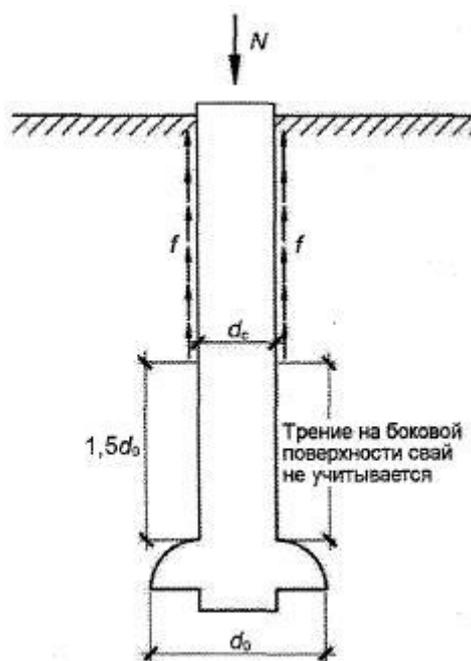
Схема к расчету сопротивления на боковой поверхности ствола сваи с уширением в песчаном грунте
